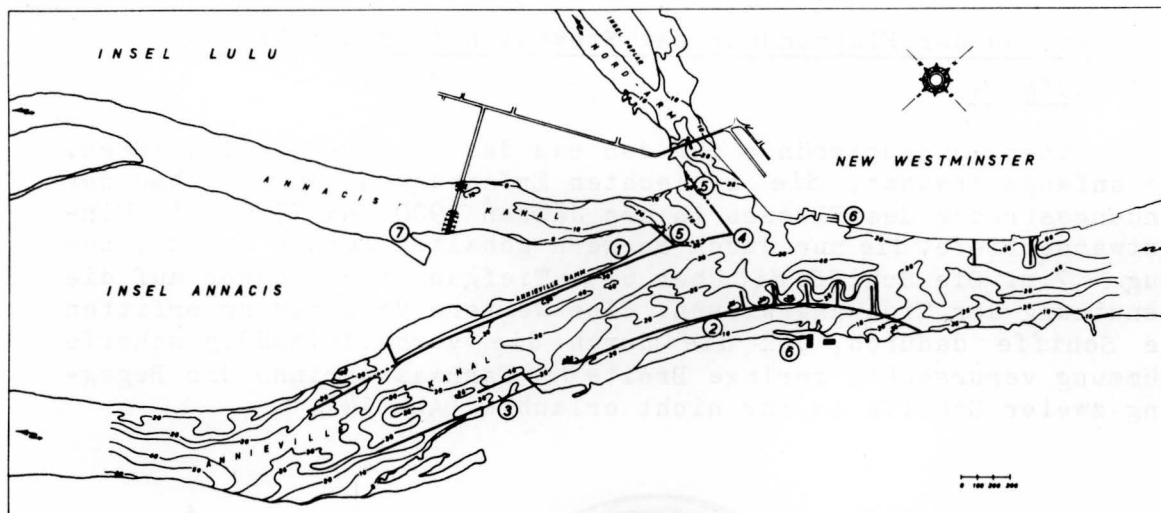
Flußbett im New Westminsters Hafen (Modell mit Einbauten)
